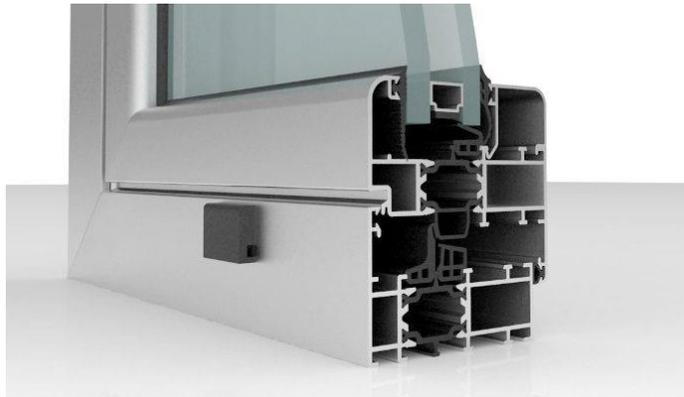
Carpintería de aluminio RPT. Fuente: [5]
